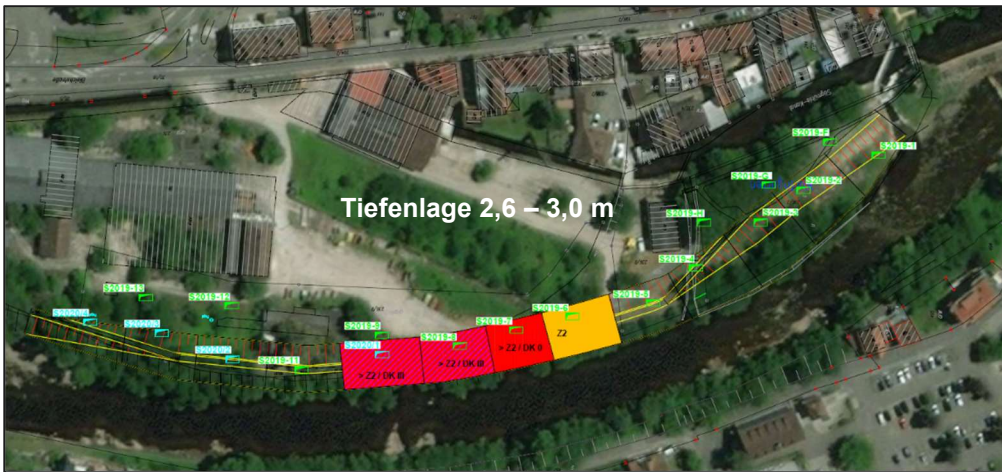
Lageplan Belastungsklassen Tiefe 2,6 - 3 m
